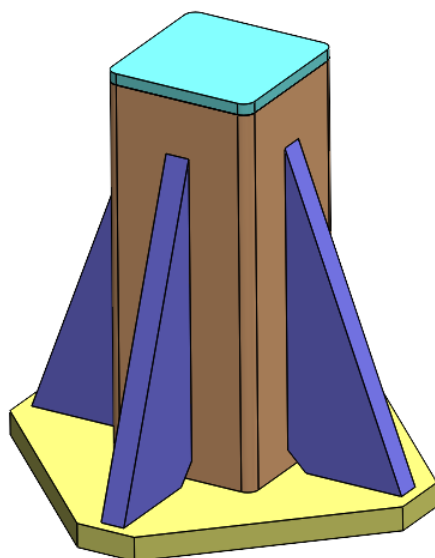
fixação do pilarete na estrutura do telhado para os pontos 23 a 29.
